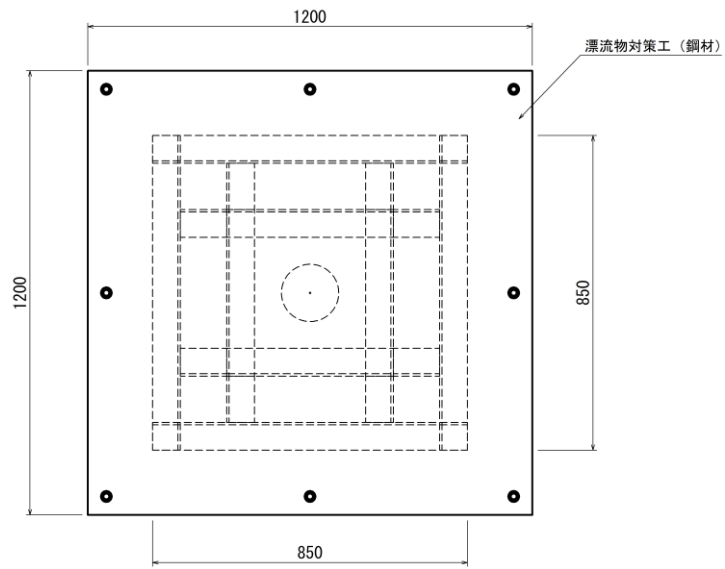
(1) 漂流物対策工 (鋼材) の構造概要図 (平面図)
